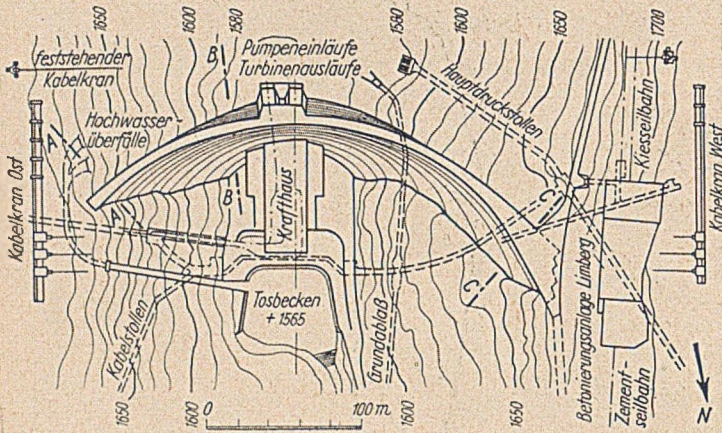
Limbergsperre. Grundriß und Querschnitte.
